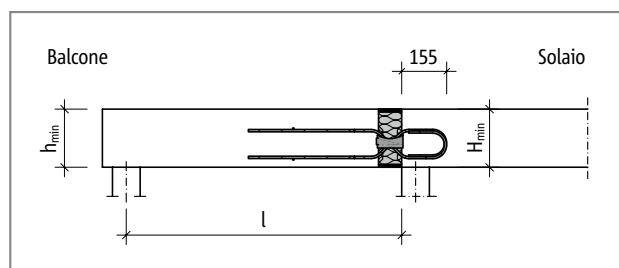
Schöck Isokorb® T QL-VV1 - tipo QL-VV3: schema statico
